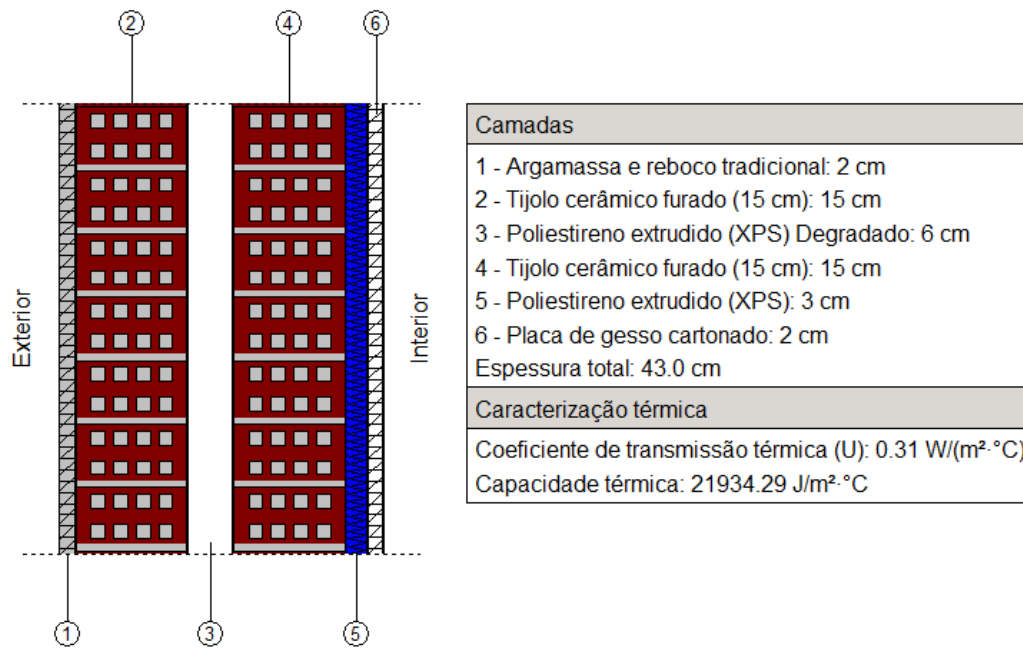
Vista de corte da parede exterior da medida de melhoria 8
